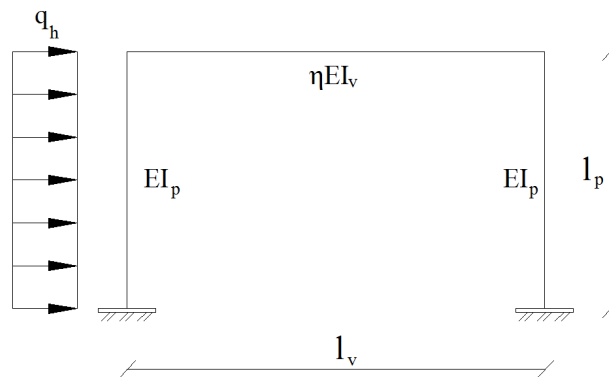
Ponderação da rigidez da viga do módulo.
